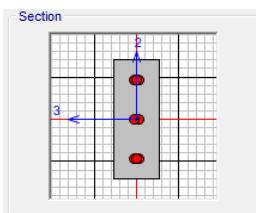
Eixos locais das vigas do exemplo 1 (SAP2000)
